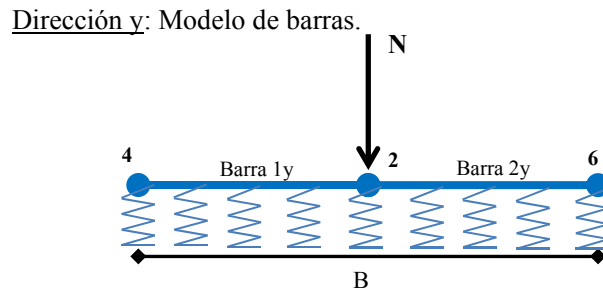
Zapata Aislada. Modelo elástico de tensiones. Equilibrio
